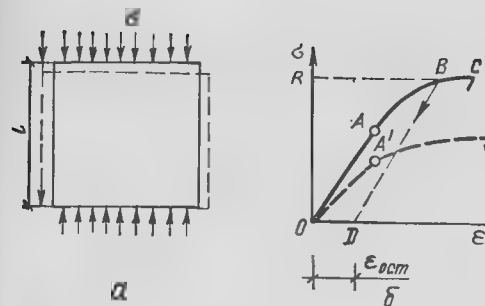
Испытание на одноосное сжатие бетонного образца:
